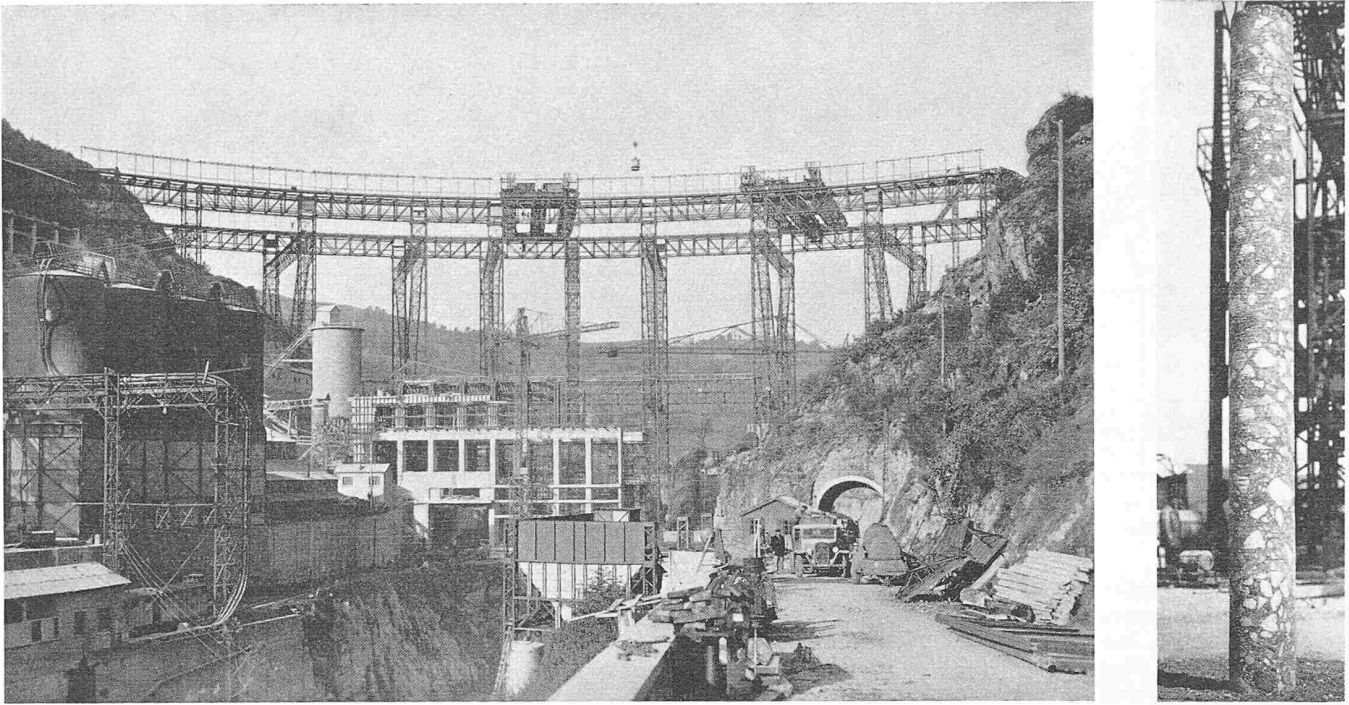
Kraftwerk Bort, Bauinstallationen, und Bild 84 (rechts) Bohrkern \varnothing 300 mm aus der Staumauer
